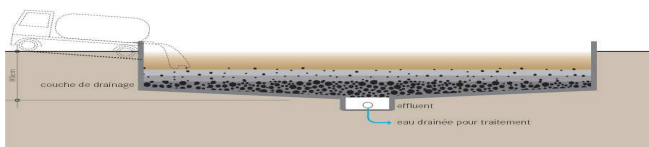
une coupe transversale d'un lit de séchage de boues (source: Tilley et al., 2008).
